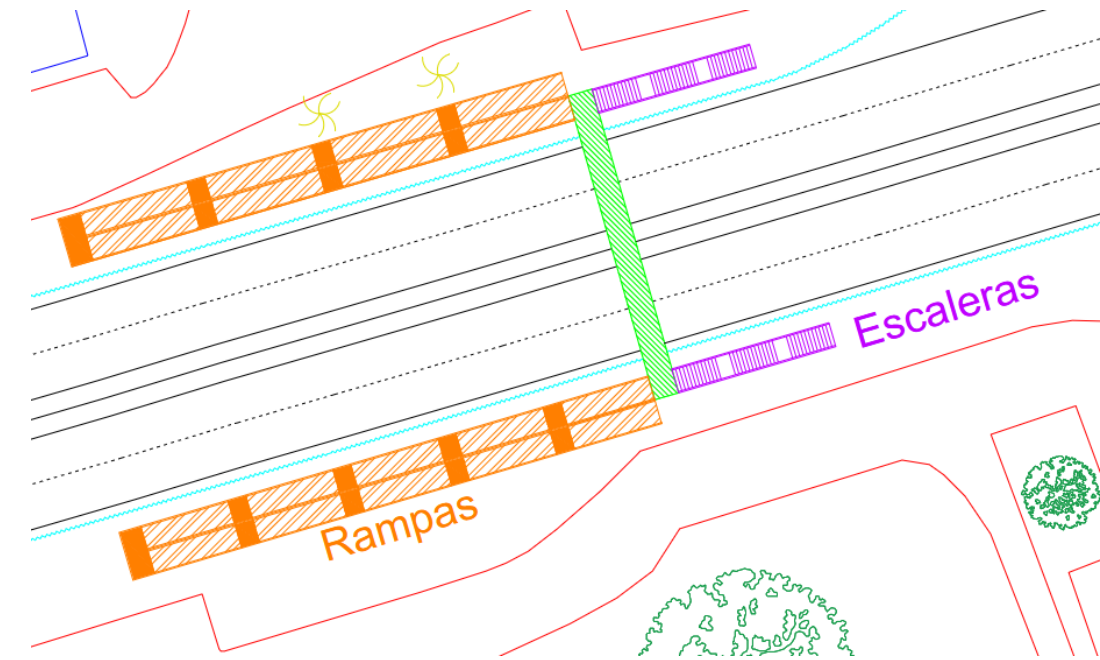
Posición de las rampas y escaleras en planta; Fuente: Elaboración propia
